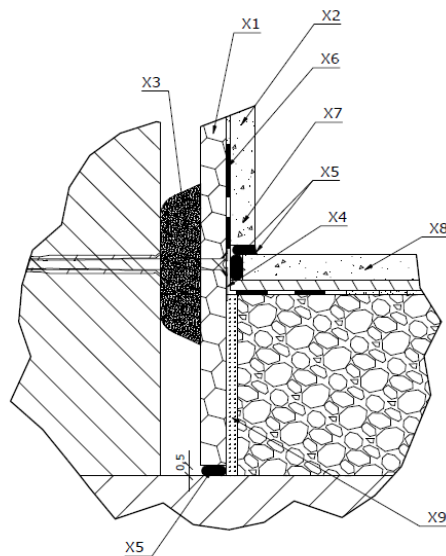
pose sur ossature bois, détail pied de paroi sur plancher avec chape
